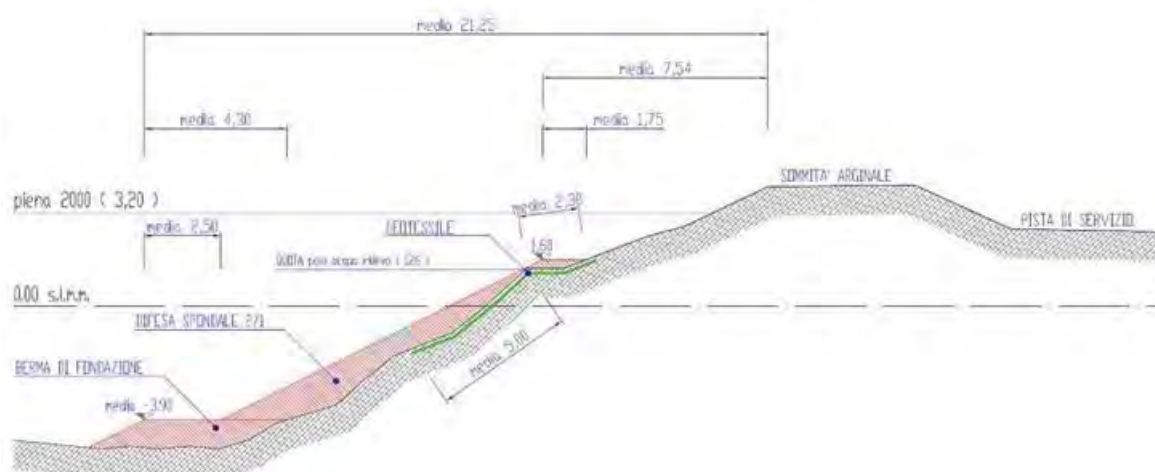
Esempio 2: sezione tipo difesa spondale Po.
